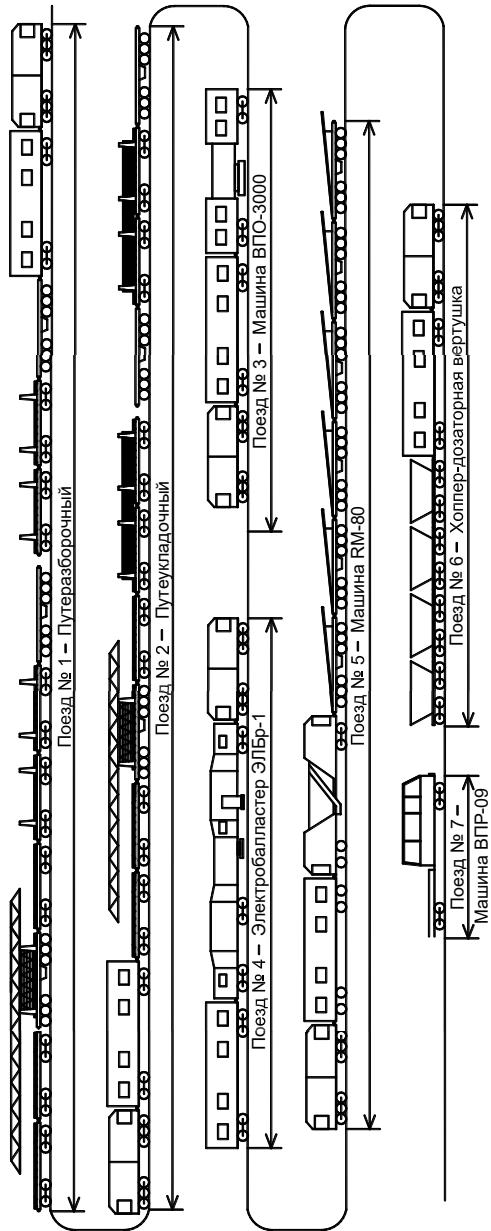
Схема формирования хозяйственных поездов на станции перед выходом на перегон
